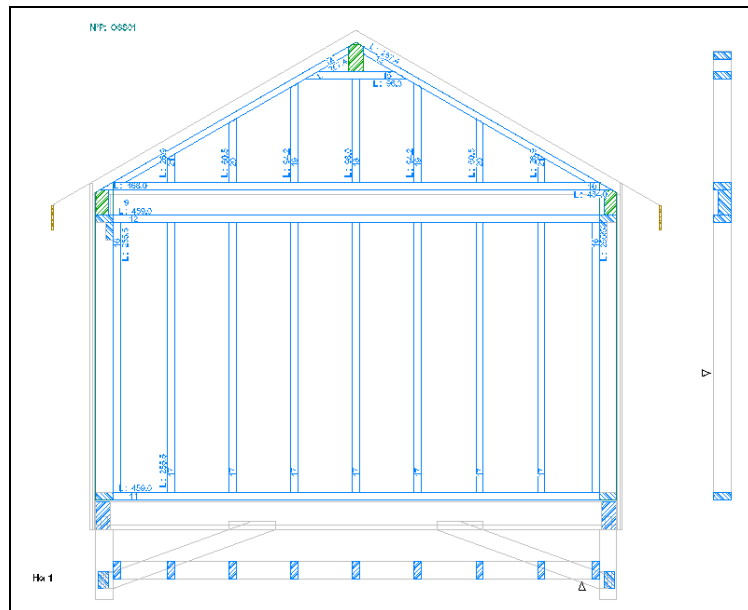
Plan en élévation de la cellule (fourni par l'entreprise de construction)
